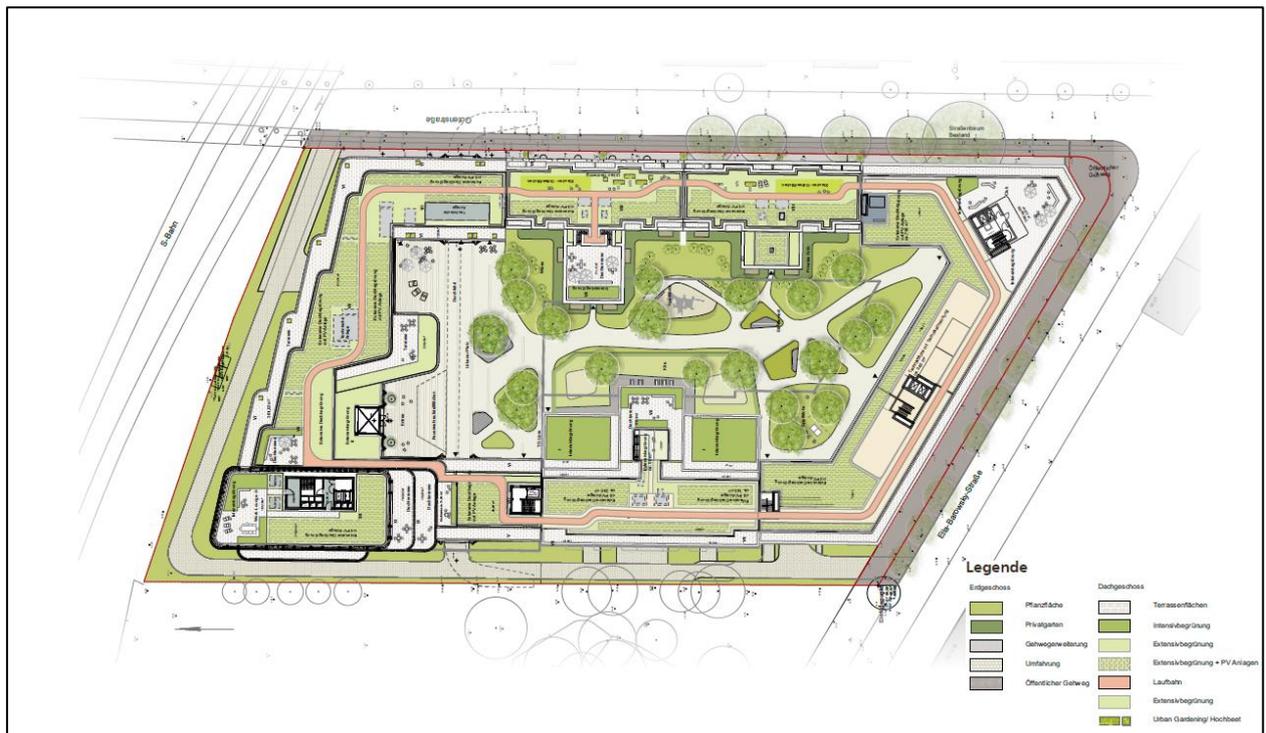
Lageplan und Landschaftsplan mit Innenhof- und Dachbegrünung (Planstand 12/2023) (HINES 2023)
